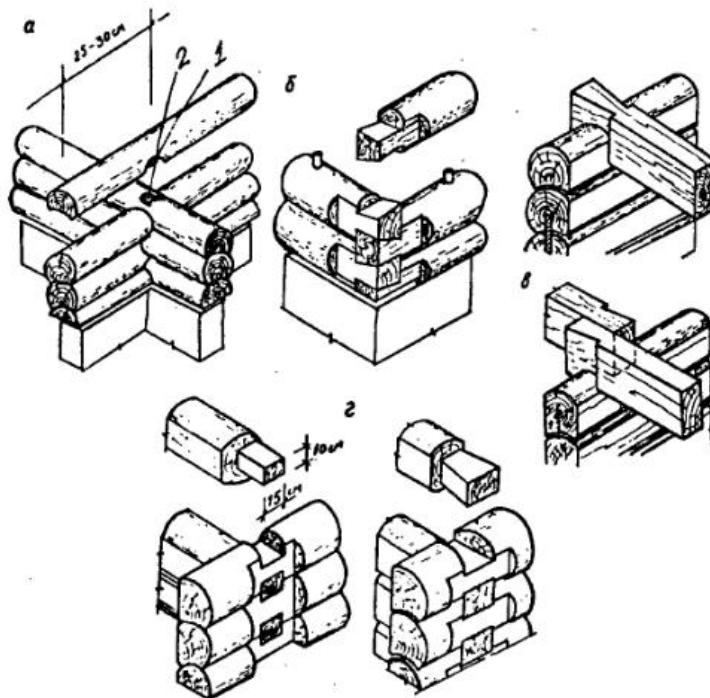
Стены деревянные бревенчатые: а — рубка угла в «чашу» (с остатком); 1 — шип, 2 — гнездо; б — рубка угла в «лапу» (без остатка); в — врубка в стену балок перекрытия; г — примыкание внутренней стены к наружной.
